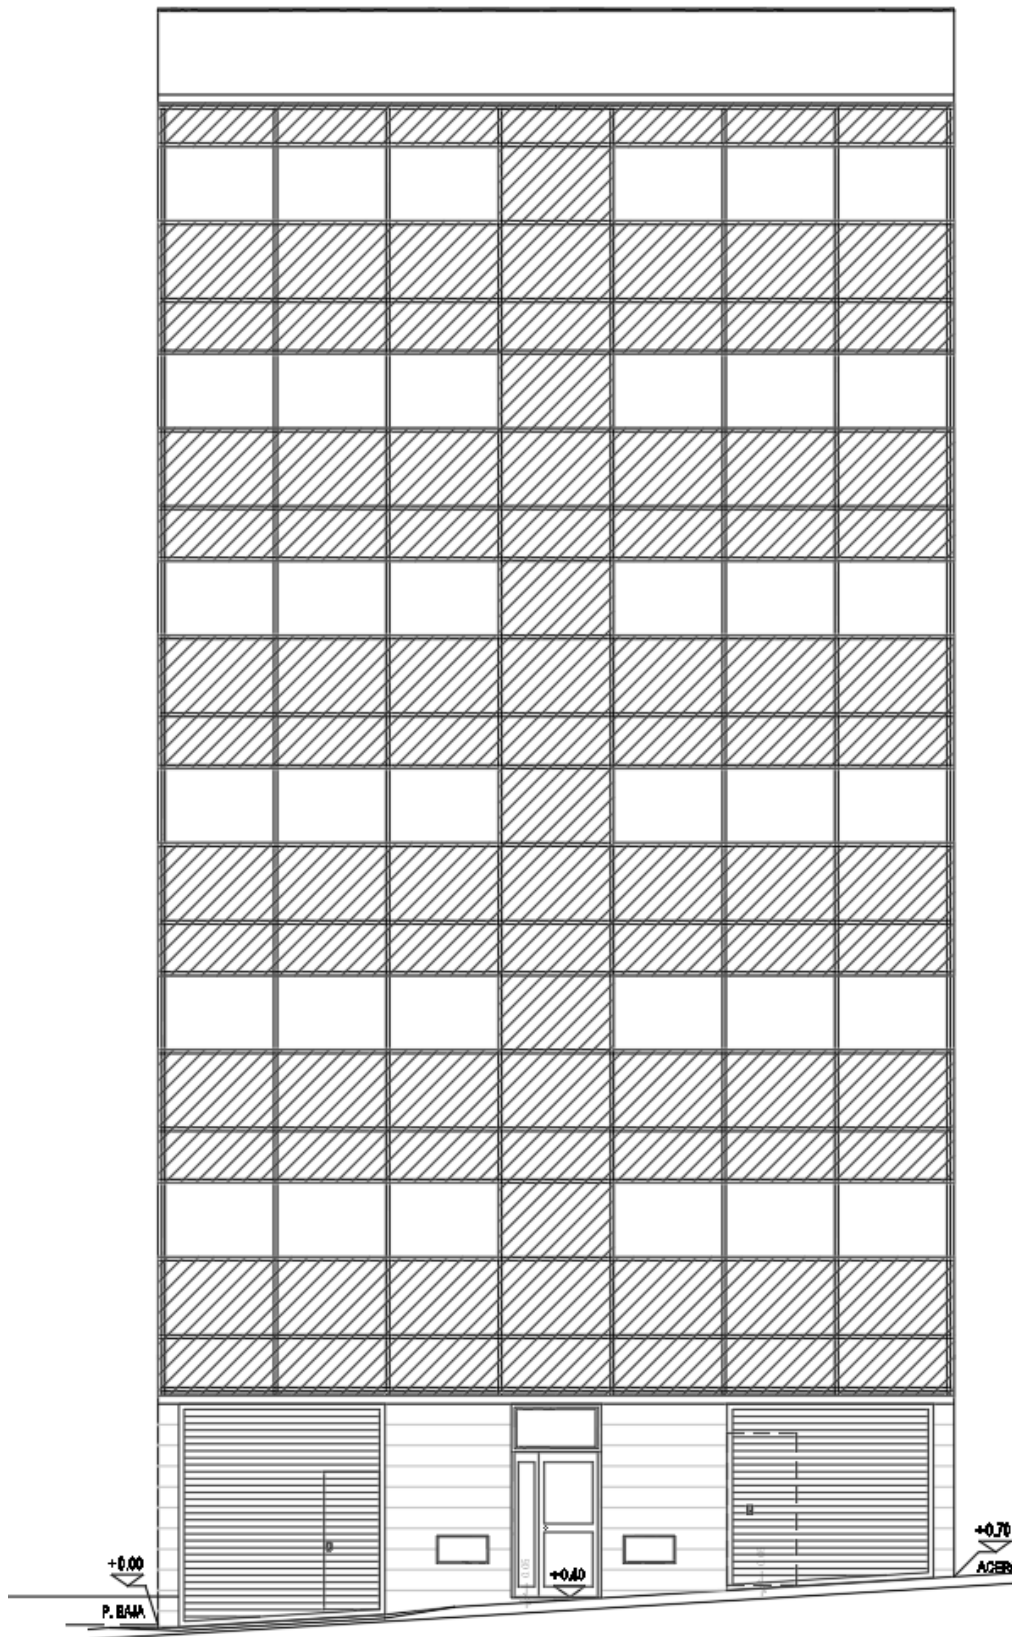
Muro Cortina 66.6% opaco Fuente:propia
